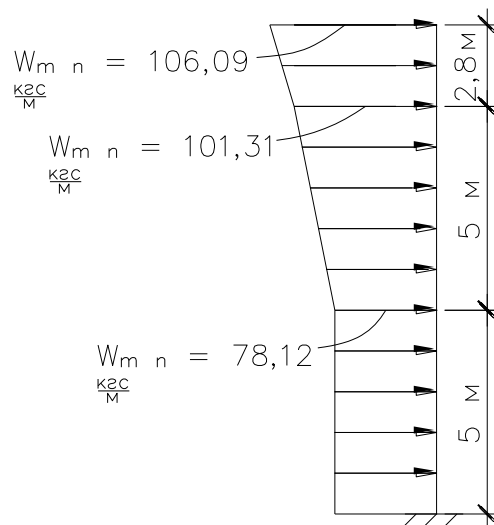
Эпюра ветровой нагрузки на подветренную сторону
